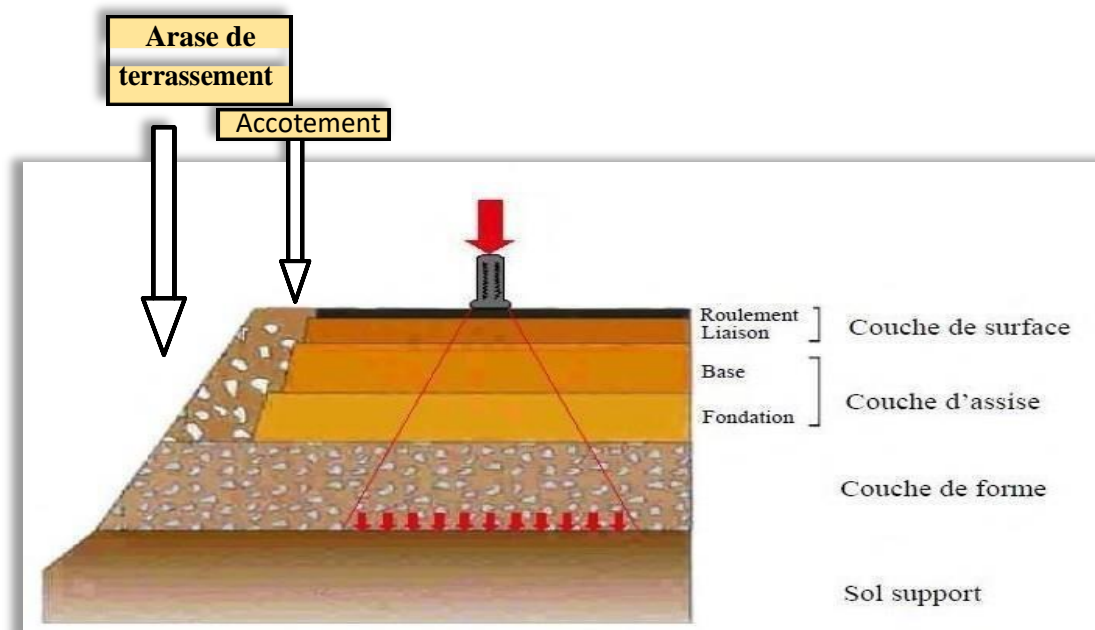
Coupe d'un type de chaussée routière [5]
